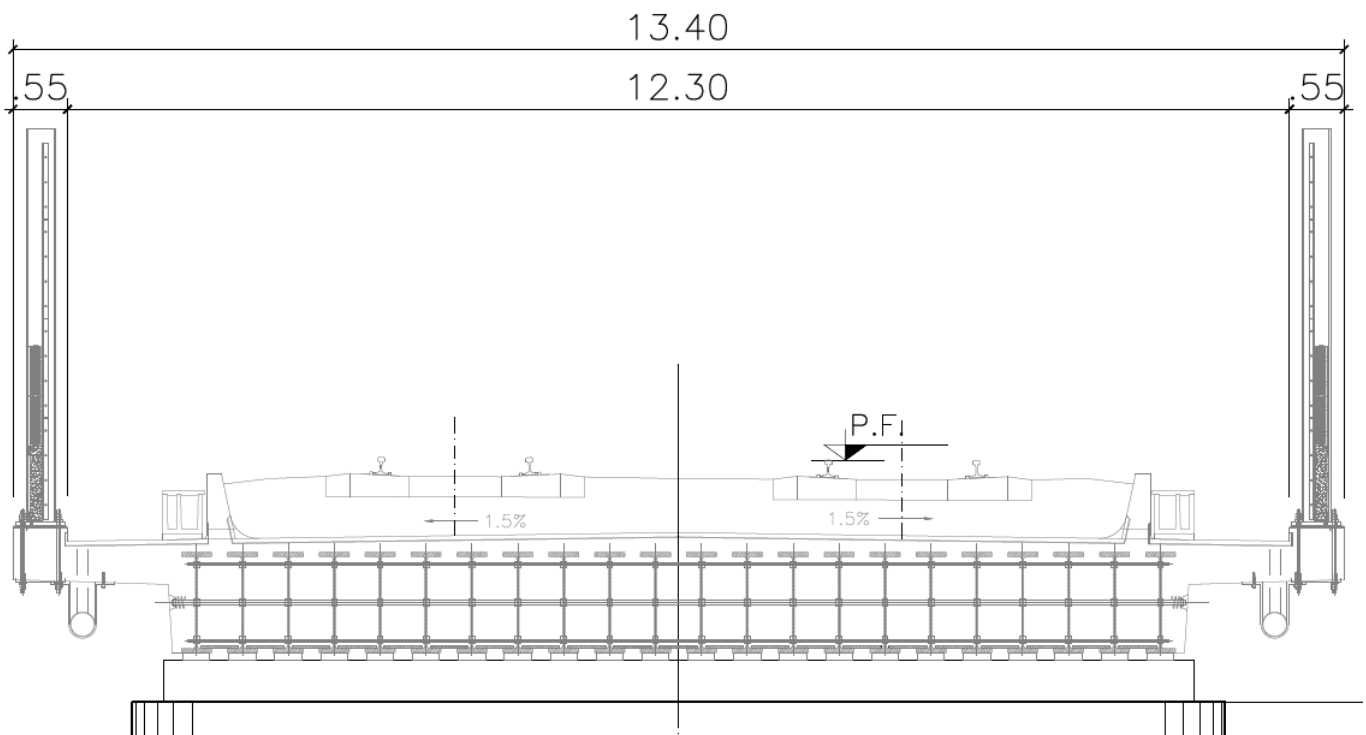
Sezione tipo - trasversale impalcato con travi c.a.p.
